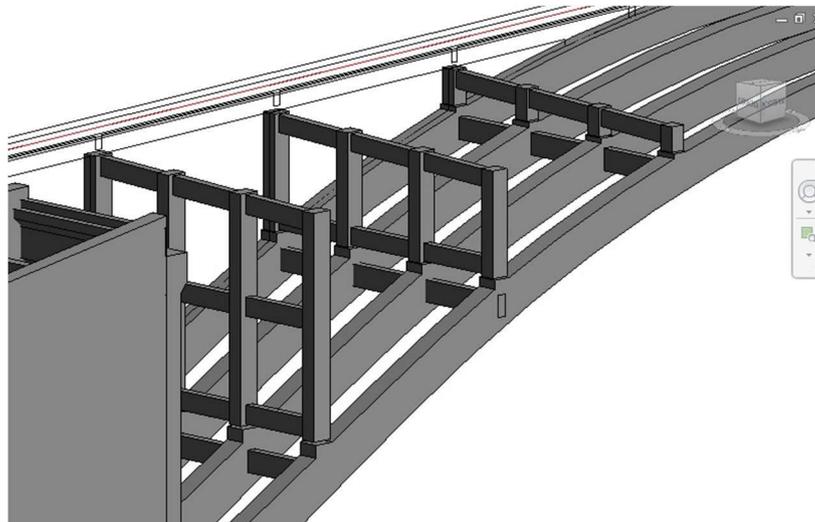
Dimensionamiento de Vigas y tímpanos de concreto
